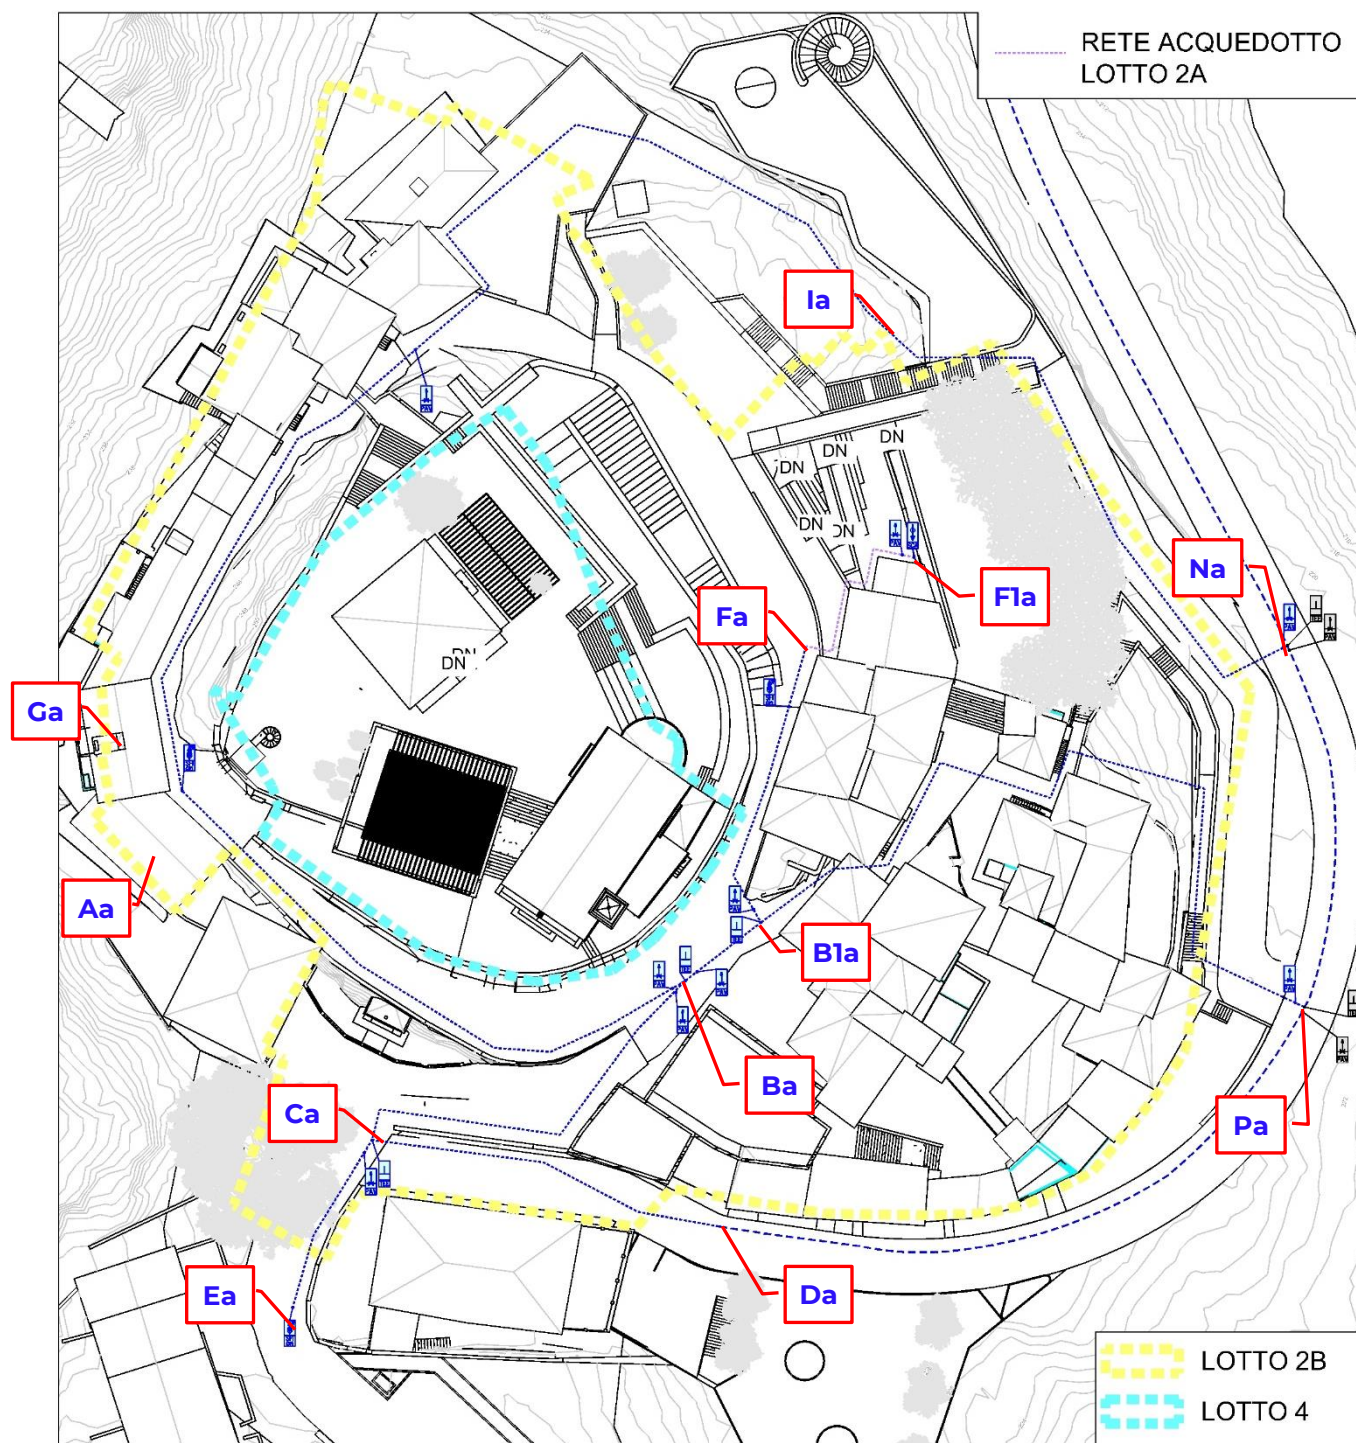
planimetria della rete di acquedotto all'interno del borgo.
